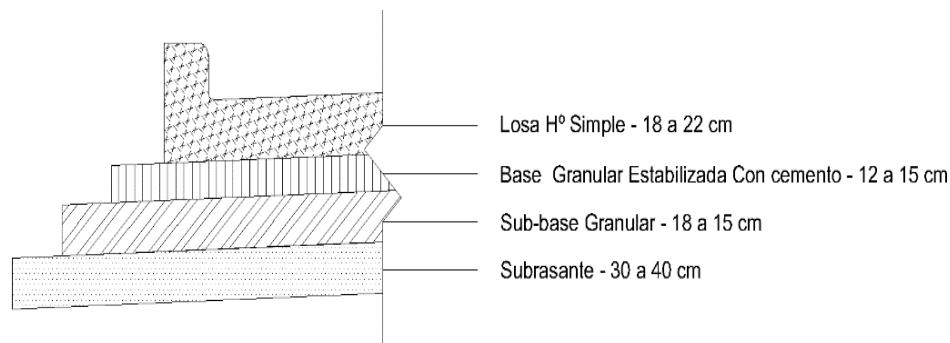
Paquete estructural pavimento rígido tipo. (Fuente: Elaboración propia).
